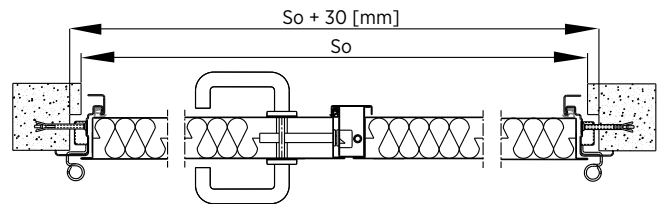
Pose entre murs d'un bloc-porte à deux battants avec bâti angulaire - coupe horizontale
